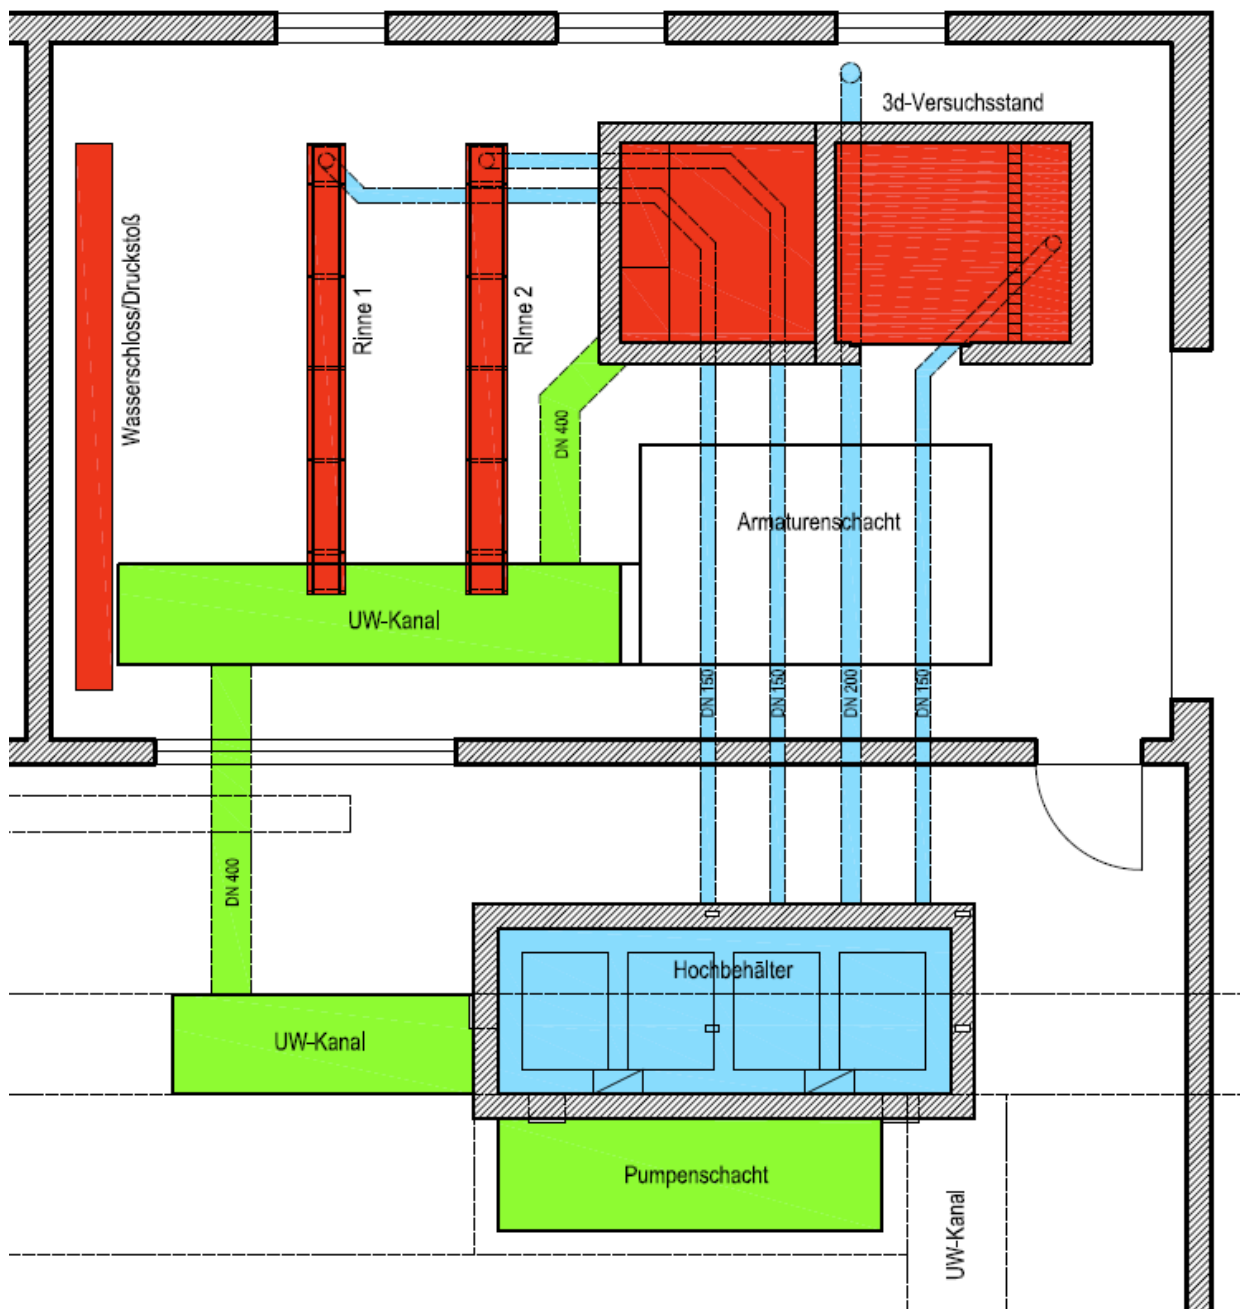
Grundriss des Lehelabors mit Hochbehälter und Versuchseinrichtungen
